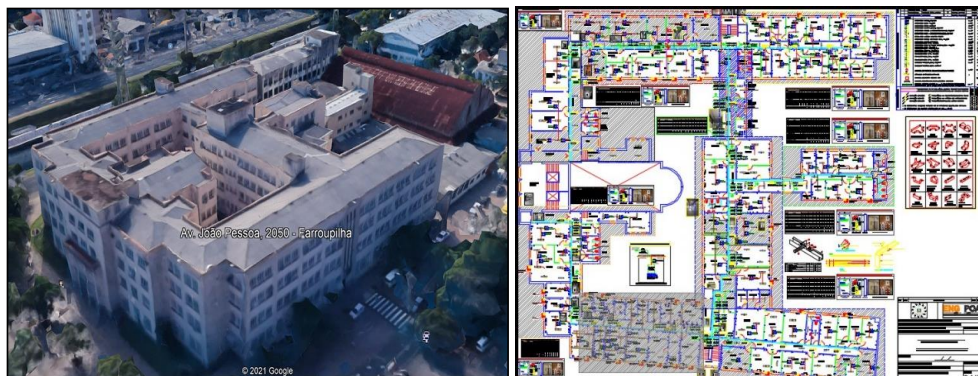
Vistas da fachada da edificação e detalhe da planta baixa do projeto elétrico para adequações das Instalações Elétricas do 3º Pavimento do Palácio da Polícia.
